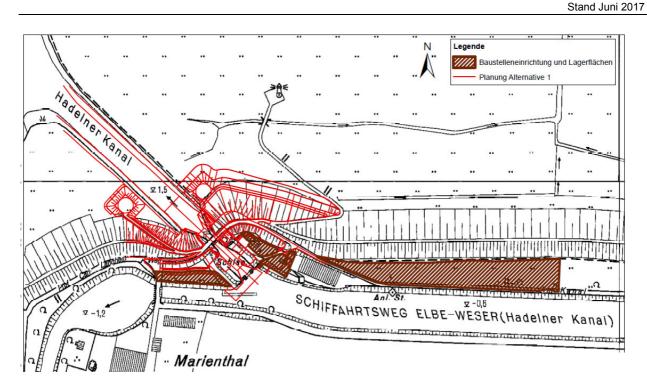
Lage Baubüro und Lagerfläche (unmaßstäblich)
